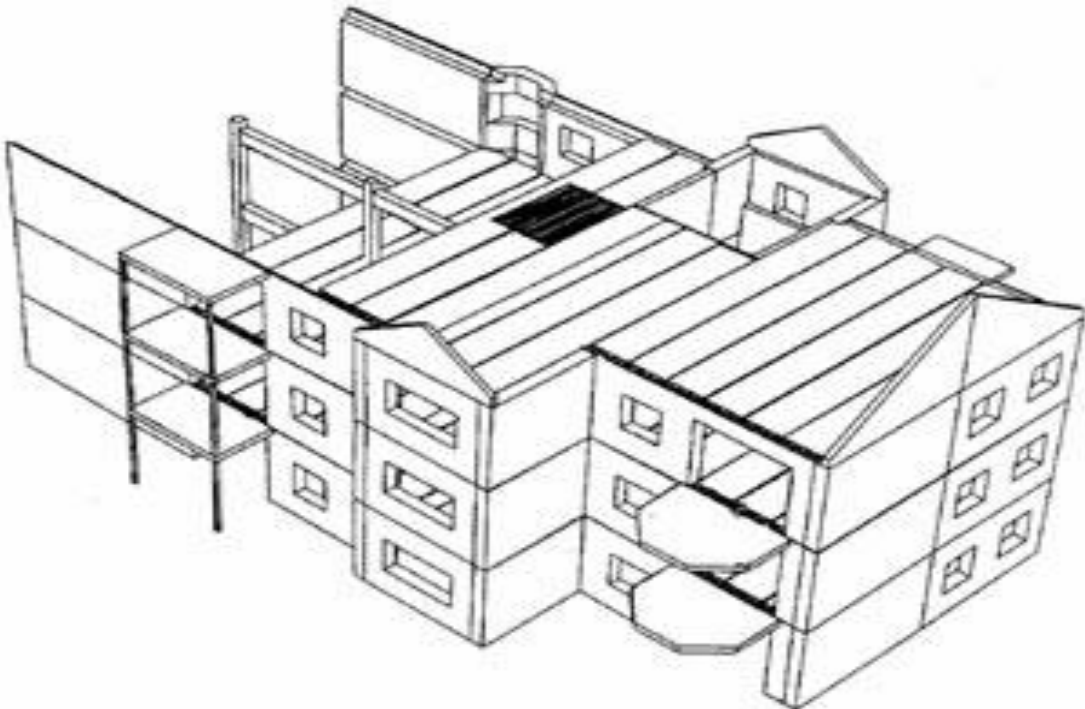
Sistema misto para edificação de múltiplos pavimentos
